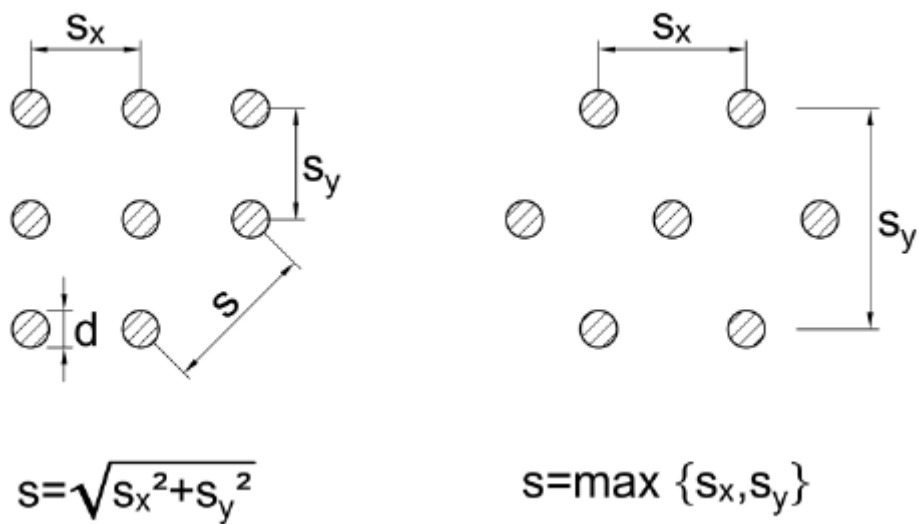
Arranjo em planta do espaçamento entre estacas (DNIT, 2022)
